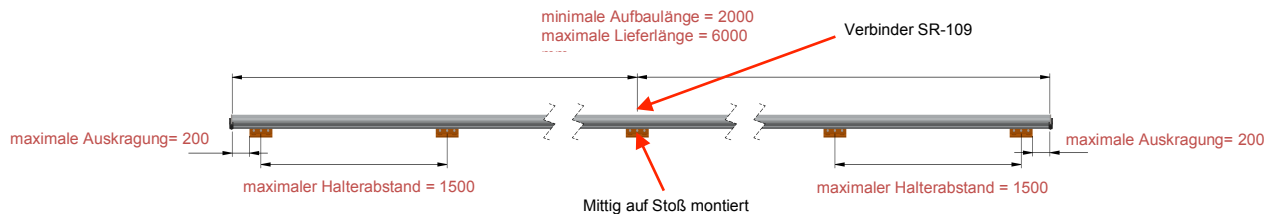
Aufbauvariante mit SR-105 auf Stoß
